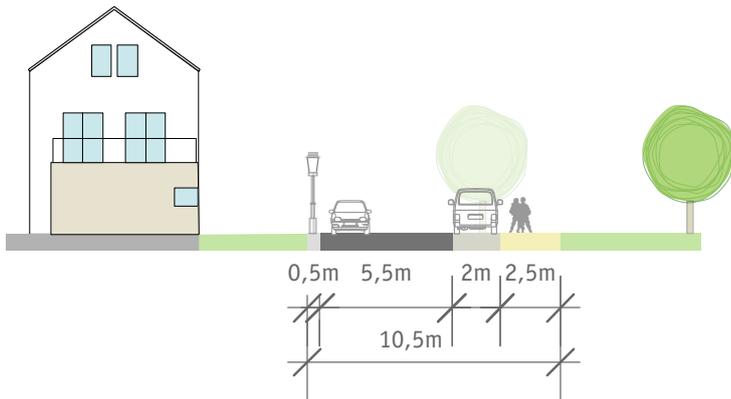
Prinzipschnitt Wohnstraße mit Gehweg und Park-/Grünstreifen
